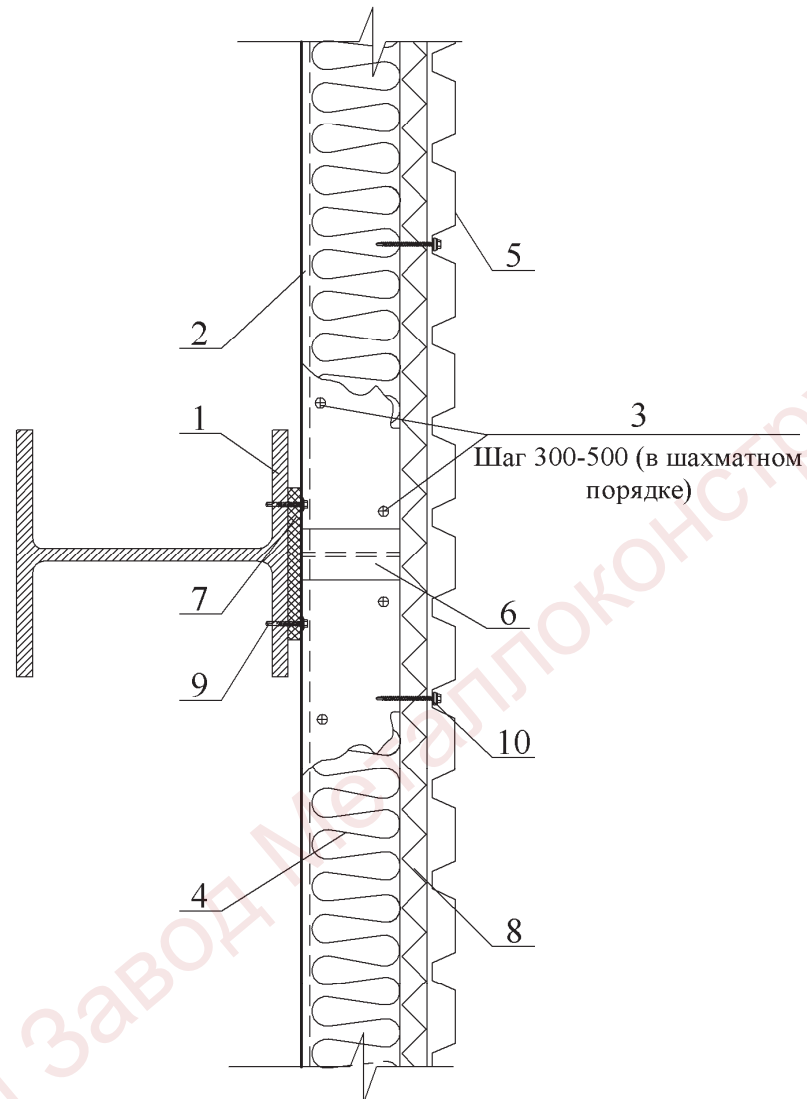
Вертикальный разрез ограждающих конструкций стен из сэндвич-профиля
